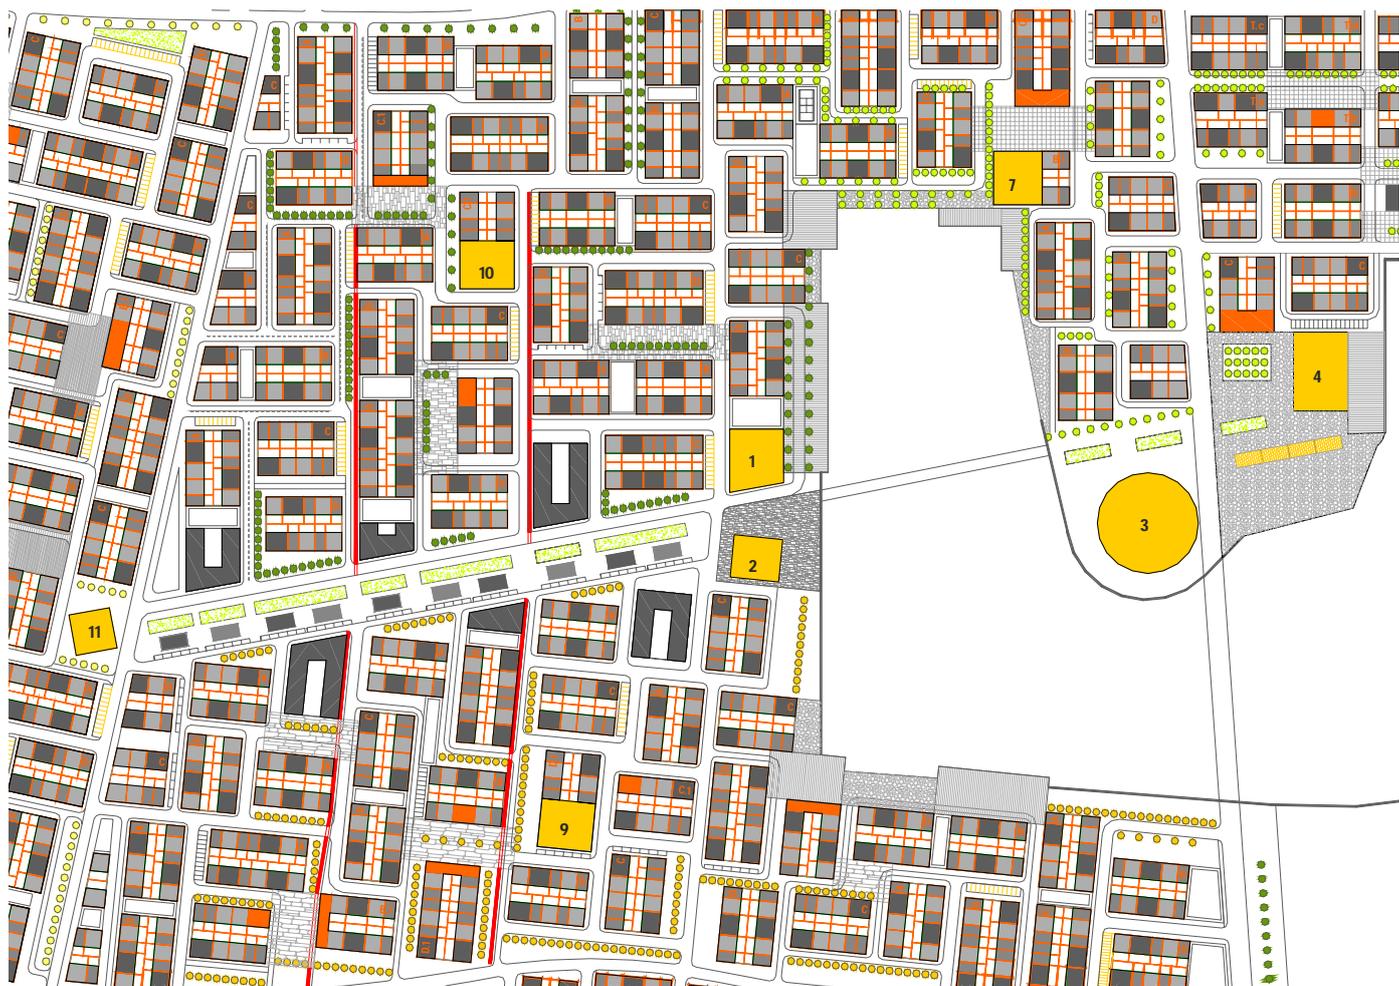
Plano do grupo M@dp – Planta de pormenor detalhada.
